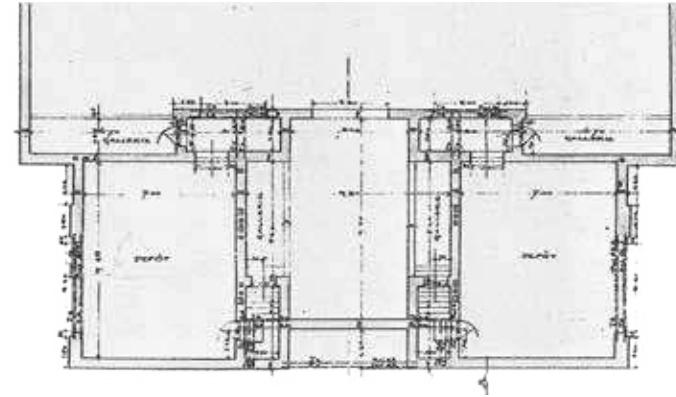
Grundriss Obergeschoss Maßstab ca. 1:350
